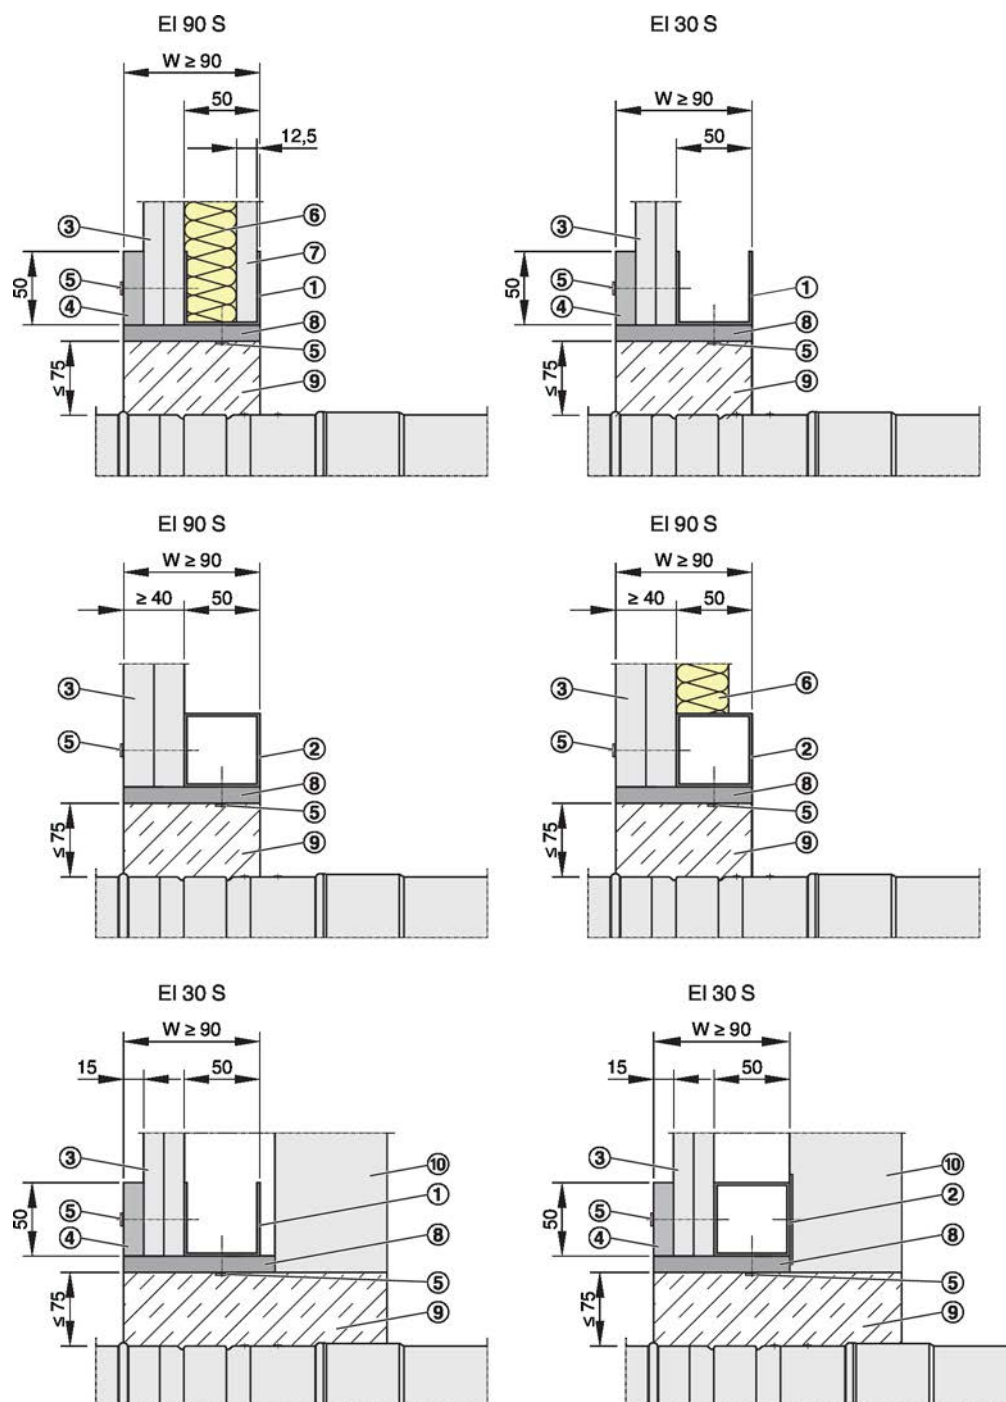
Nasseinbau in Schachtwände mit Metallständer
